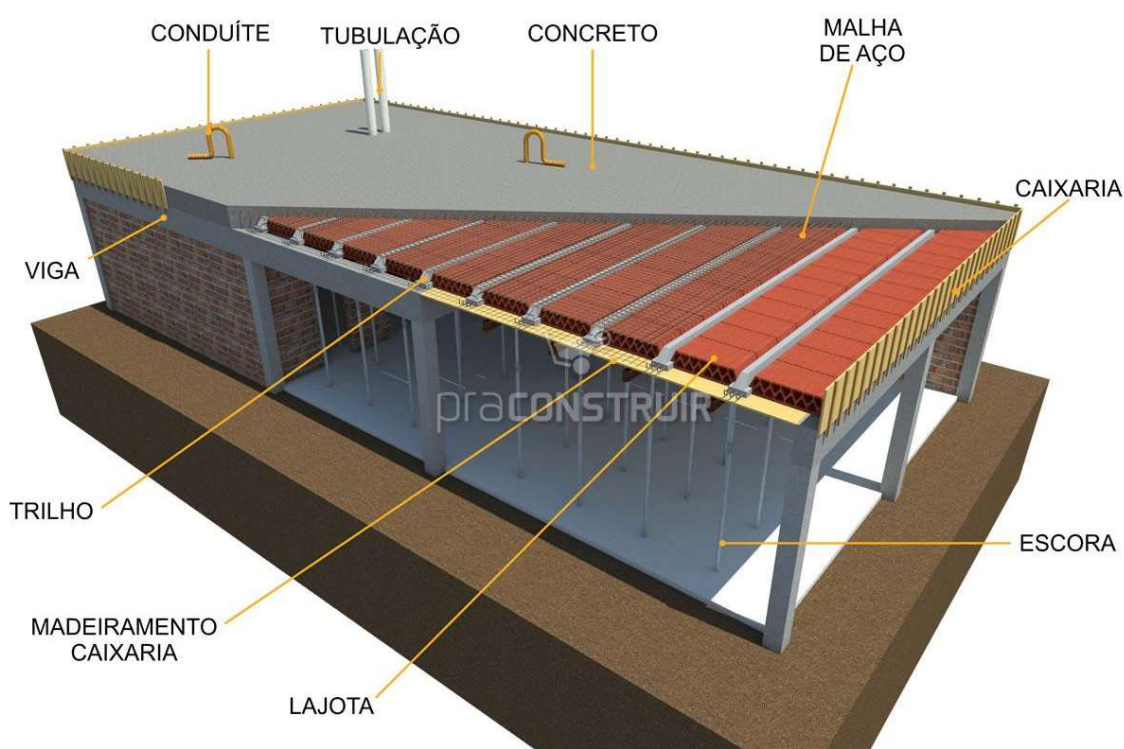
Laje pré-moldada do tipo treliçada com lajotas de blocos cerâmicos
